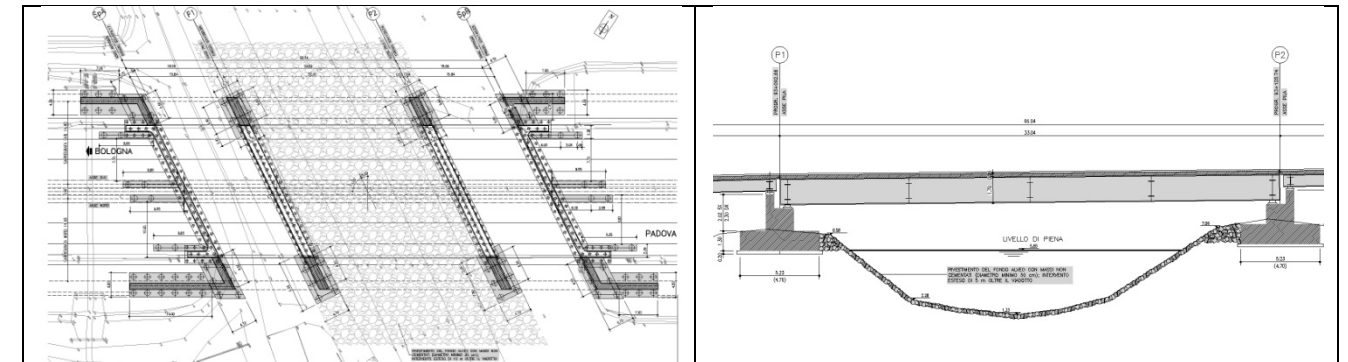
Fossa Paltana planimetria e sezione longitudinale
